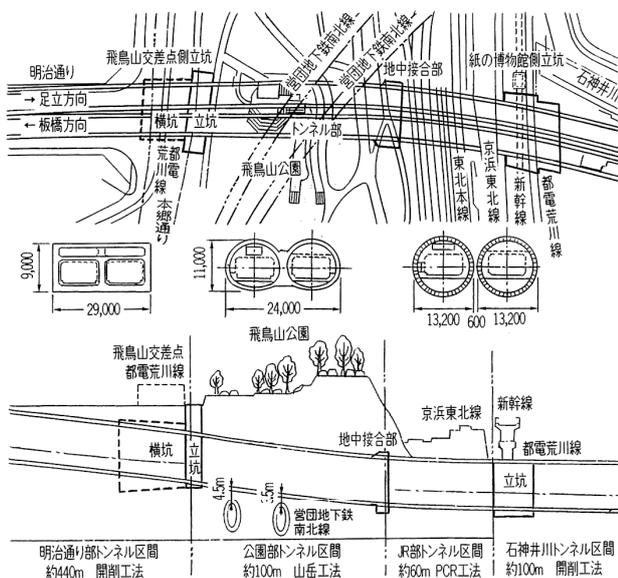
中央環状線 飛鳥山トンネル 平面図及び断面図⁸¹⁾
